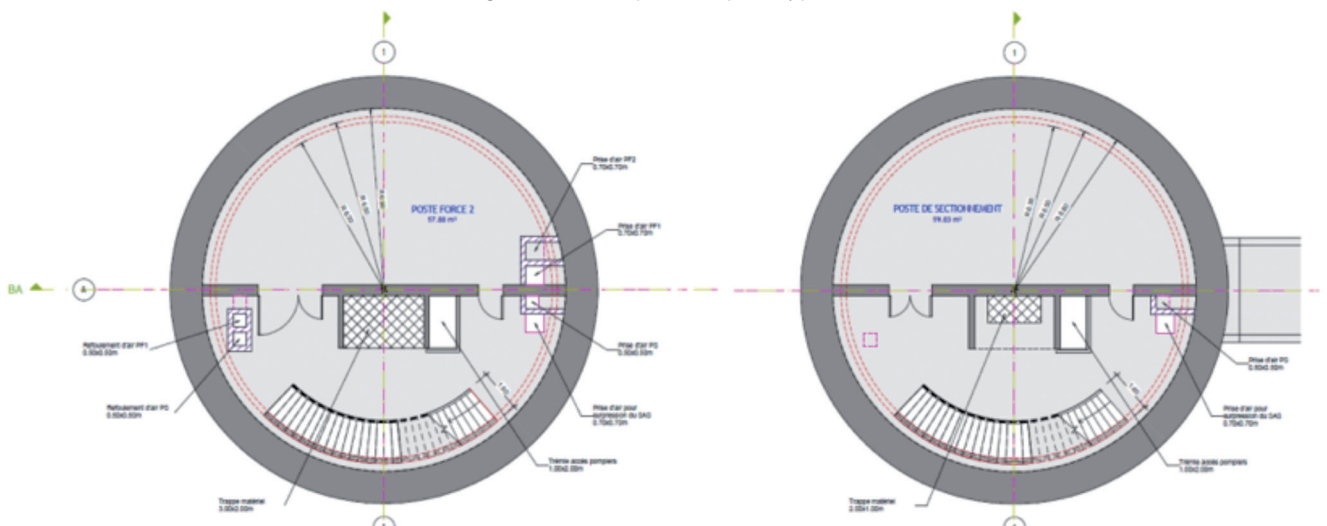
Vues en plan de plusieurs niveaux d'un puits type 2
